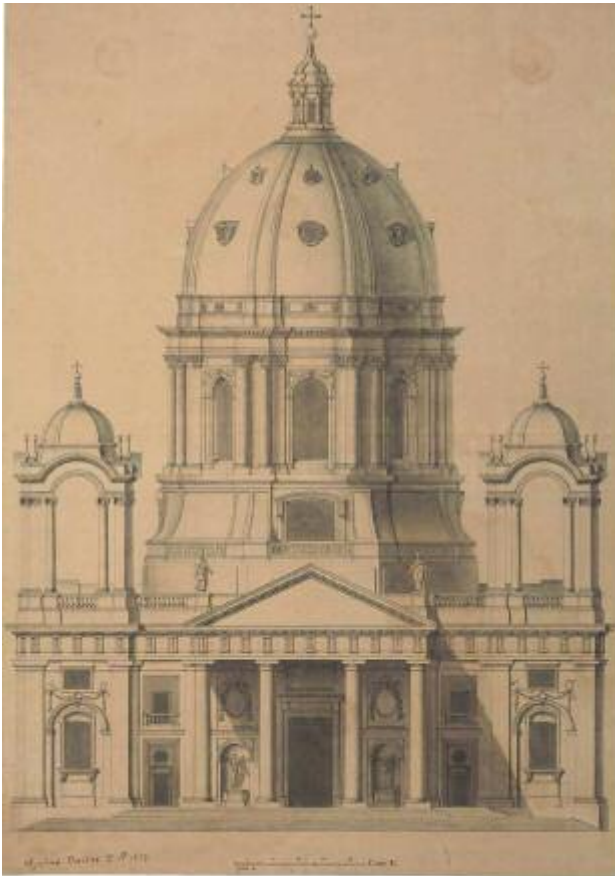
A.Ch. d'Aviler, Progetto di chiesa a pianta ottagonale, prospetto. Secondo premio, Concorso Accademico 1677, (prima classe), (AASt 005, da GUIDOBONI 2016, p. 54).
